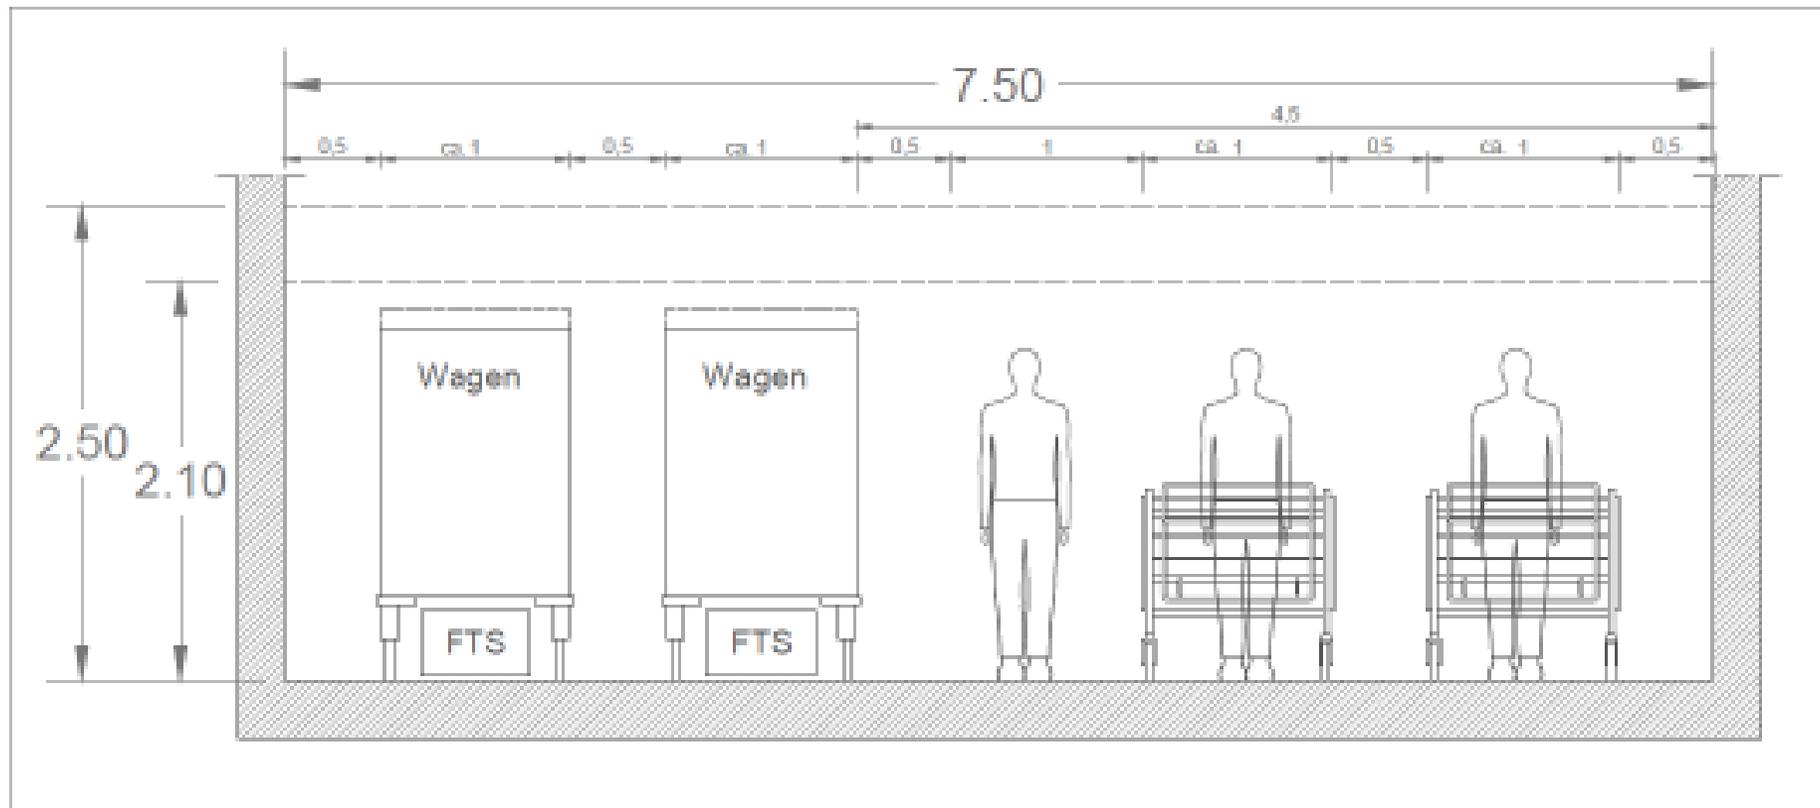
Mindestabmessungen FTS-Flur/-Tunnel (inkl. Personenkapazität und manueller Bettentransport)
